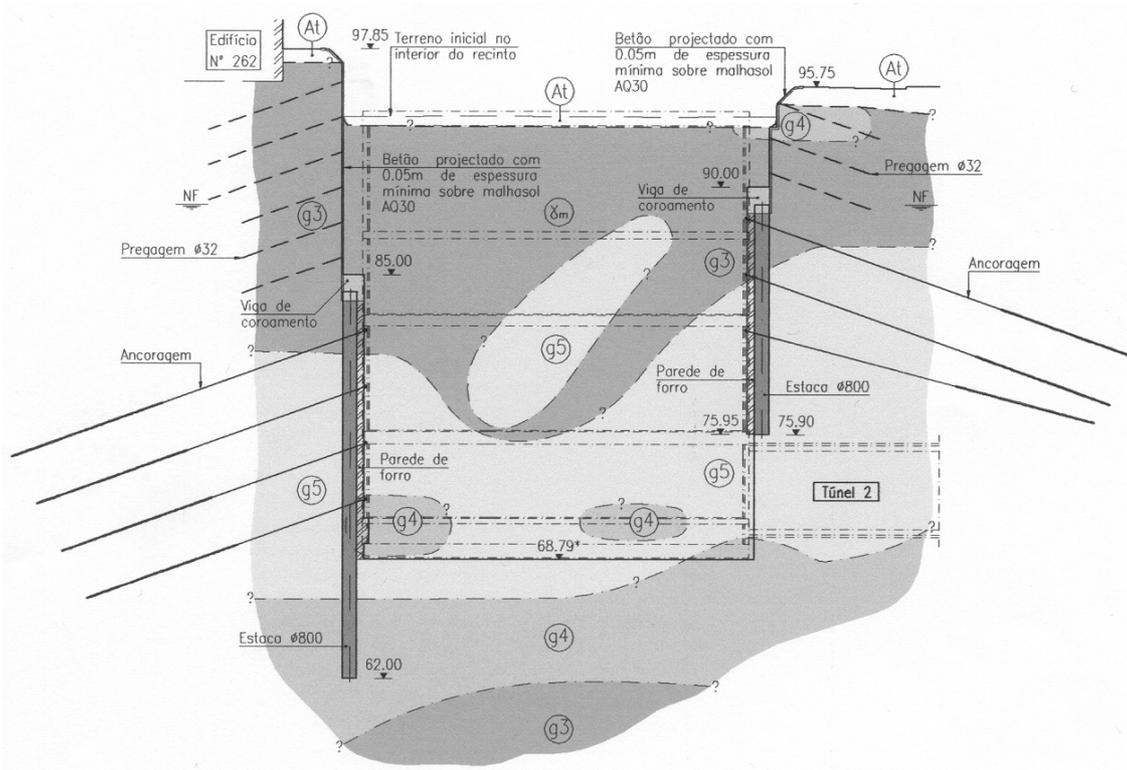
Corte transversal na zona Norte do poço (Corte A-A da Figura 1)
